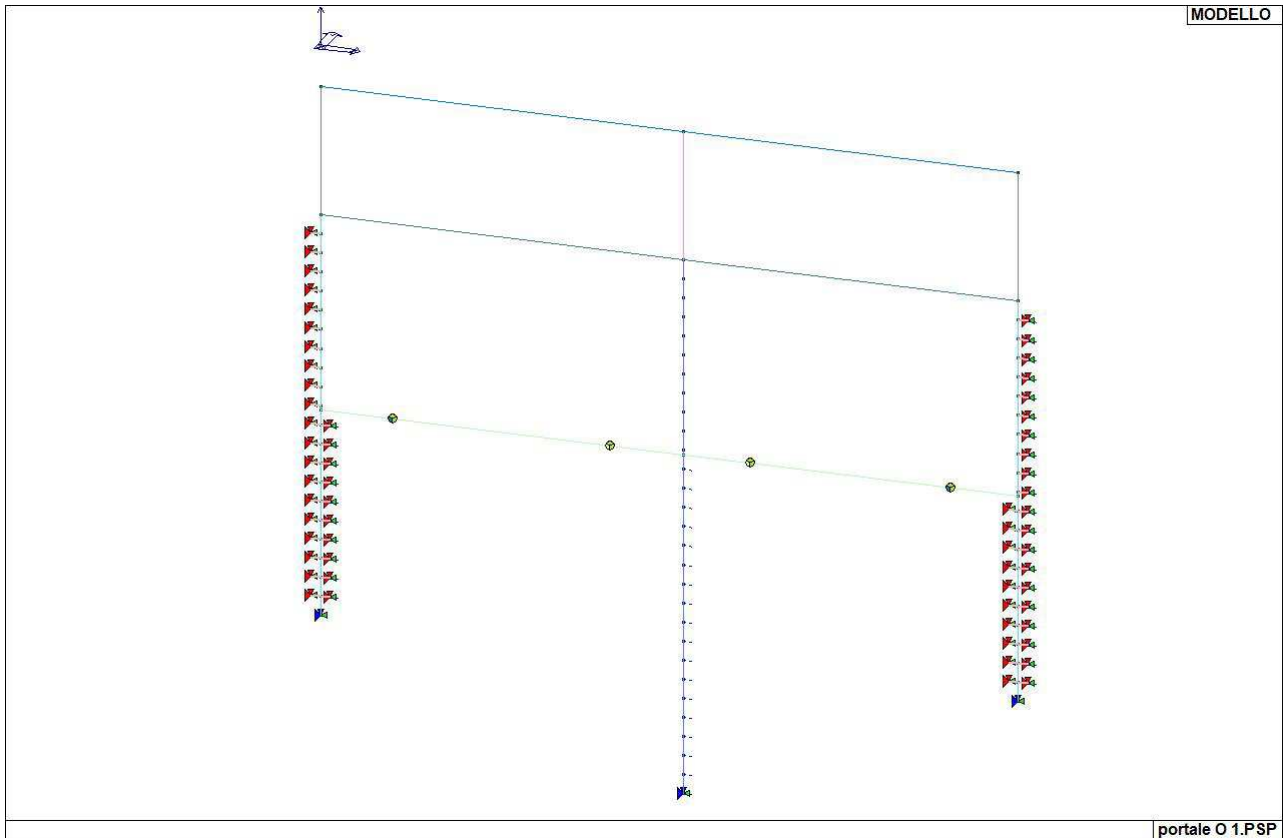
Vista unifilare del modello, sezione Tipo O (3 diaframmi)
